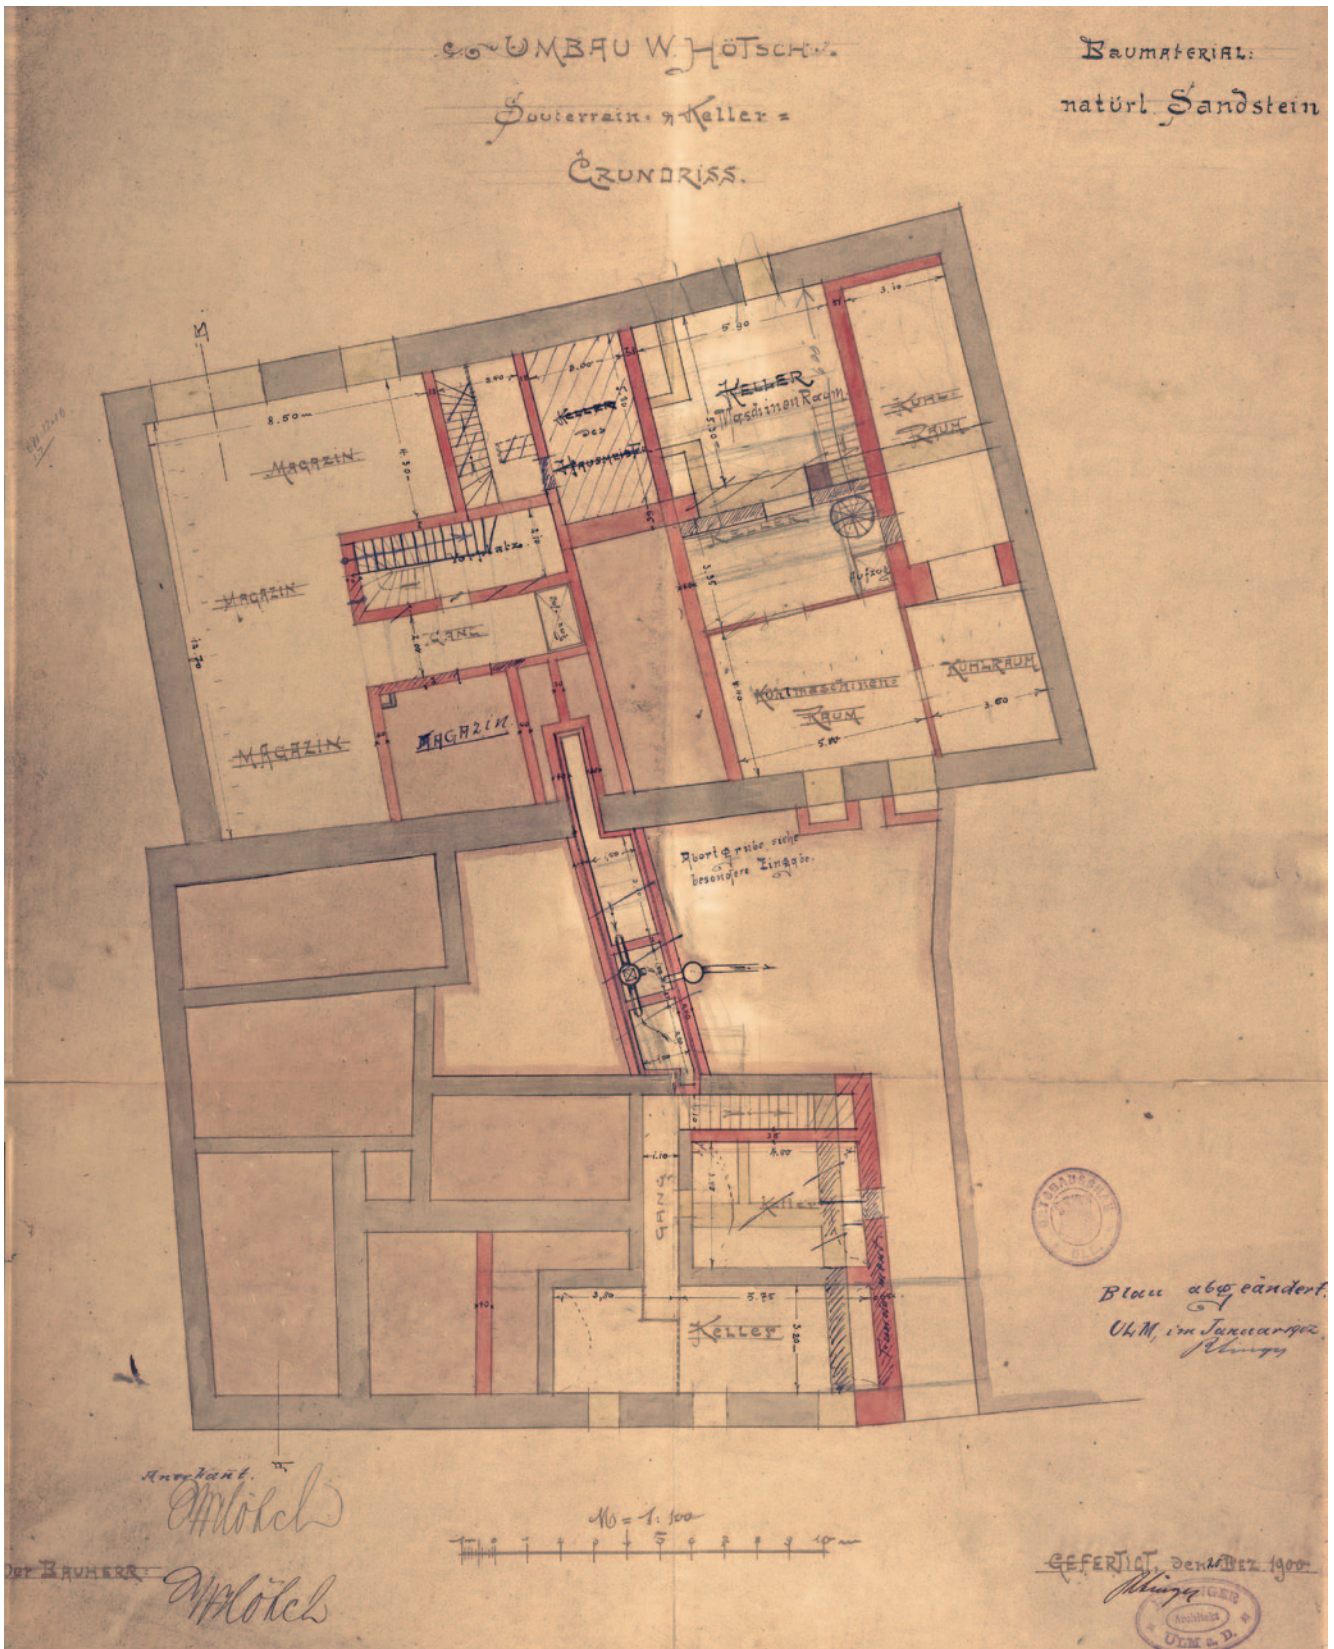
Gebäude Lange Straße 16 (A 261), Kellerplan zum Umbau des Vorder- und Hinterhauses, Baugesuch 1901, 2. Fertigung.
